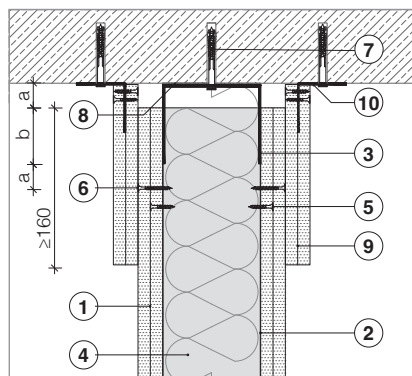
Conexiunea peretelui ($h > 6.5m$) – varianta 2 (utilizând placări laterale suplimentare)
